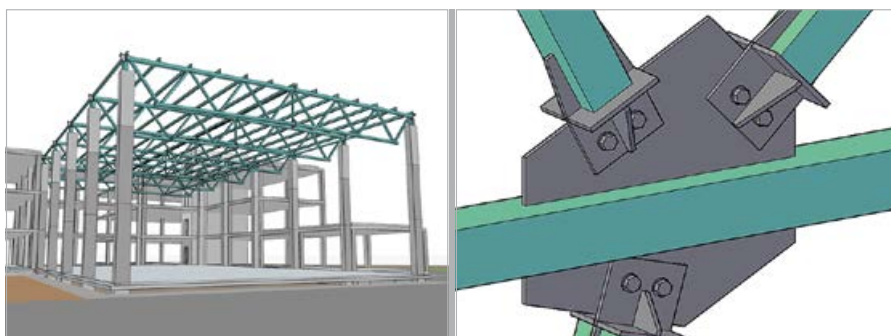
Металлические фермы покрытия и узел сопряжения металлоконструкций
